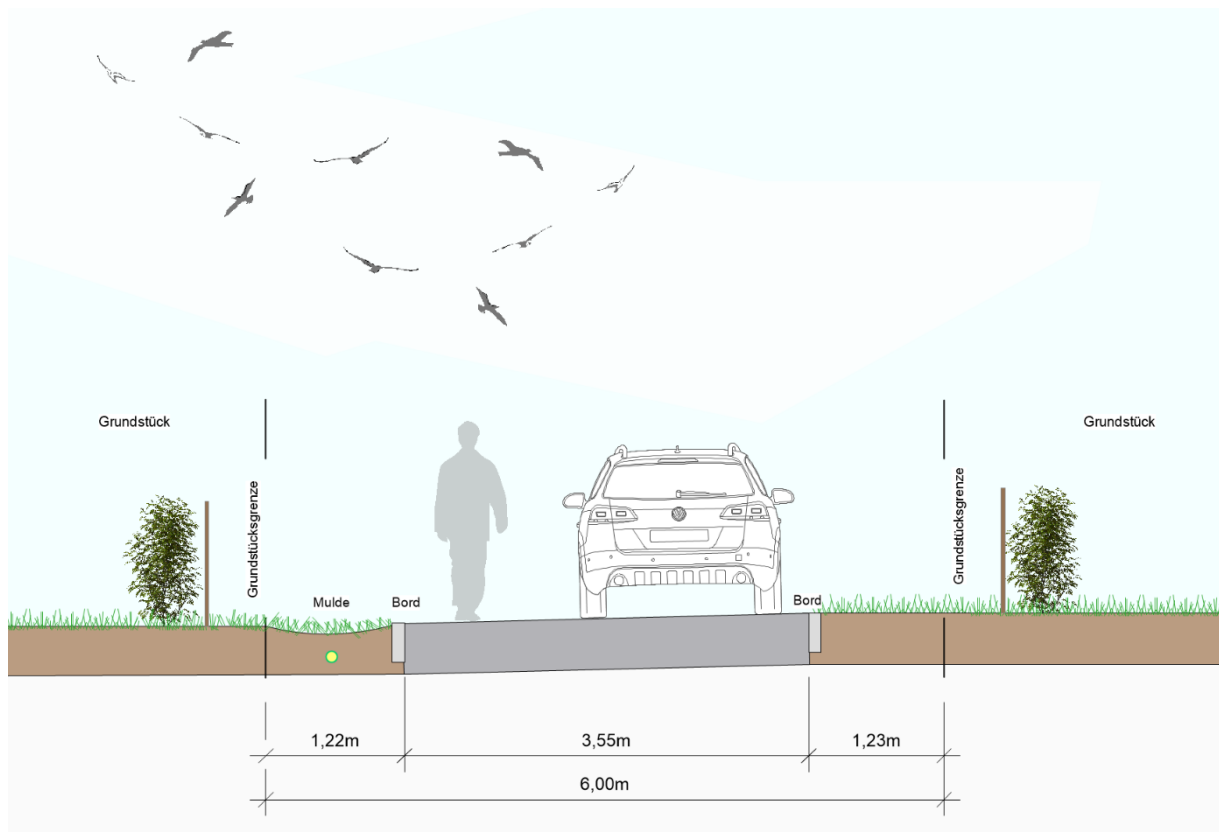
Schnitt Zufahrtsstraße – „Zum Schulmeisterweg“
